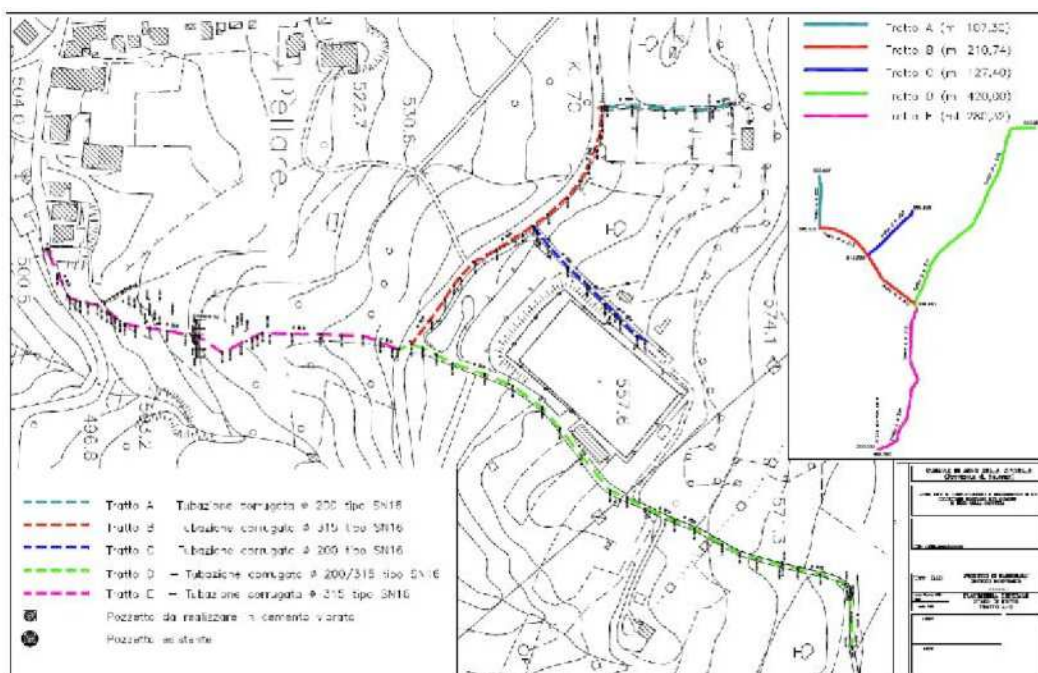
Planimetria di progetto di completamento e risanamento del collettore fognario
